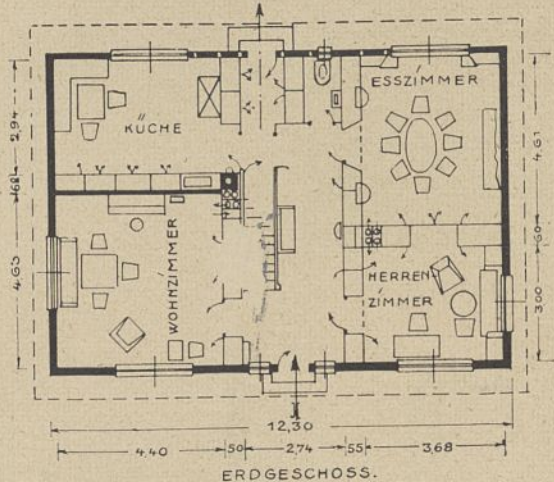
u. 36. Grundrisse zu Abb. 34.
